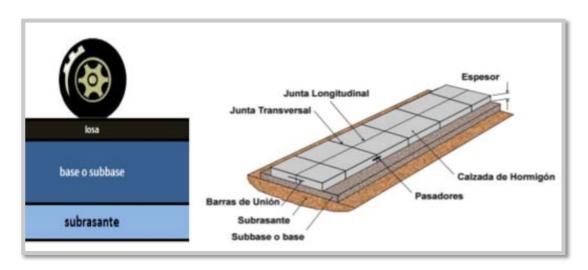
Esquema típico del paquete estructural de un pavimento rígido.
